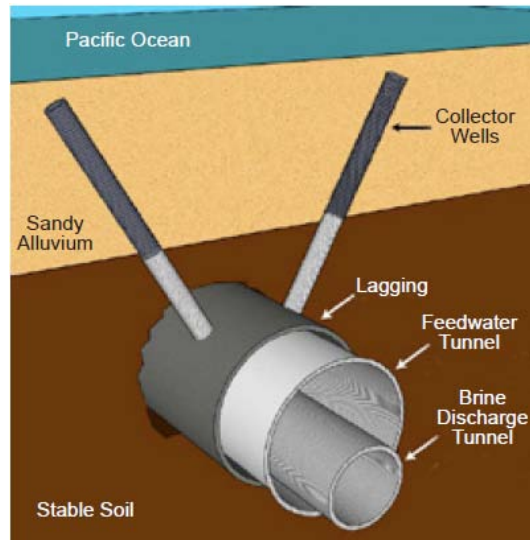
Galería de infiltración profunda. Arreglo para obra de toma y descarga
